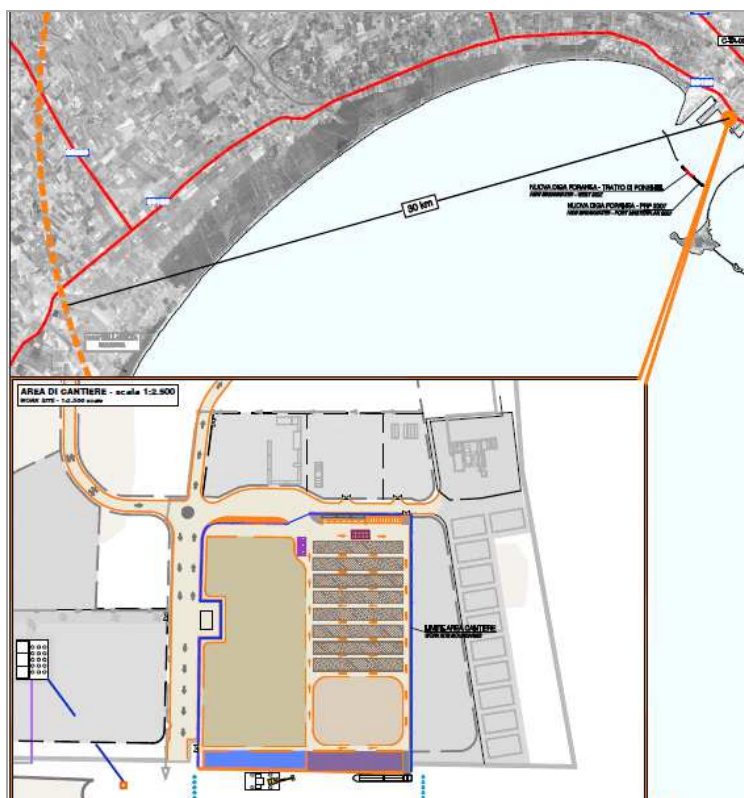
Stralcio della tavola: Carta della cantierizzazione (0130TAR03256) del SIA
